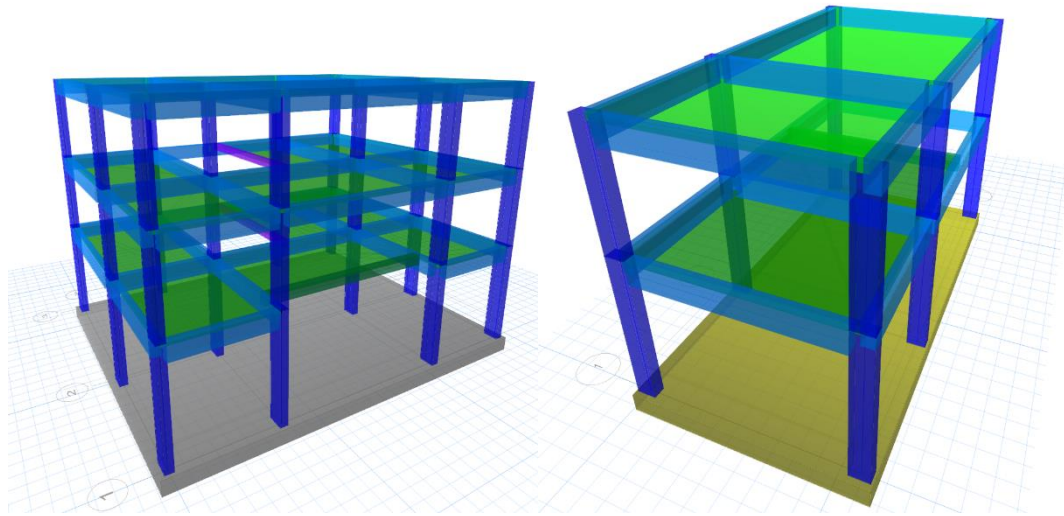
Pamje 3D e modelit të strukturës së ndërtesave me elemente të fundëm
